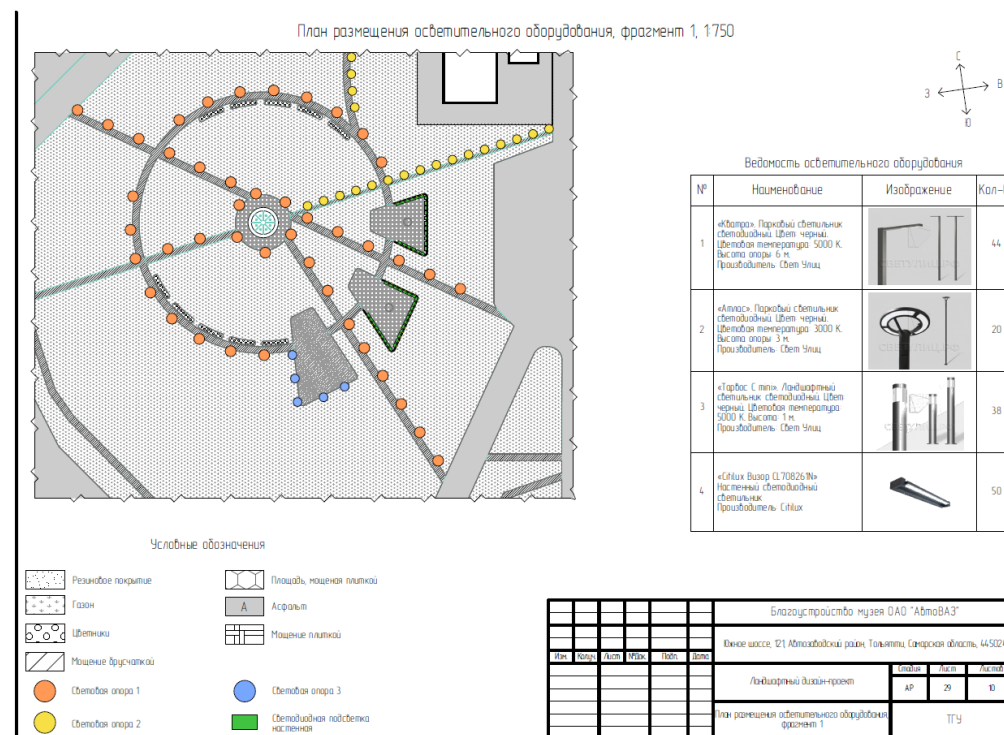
Схема плана размещения осветительного оборудования, фрагмент 1
